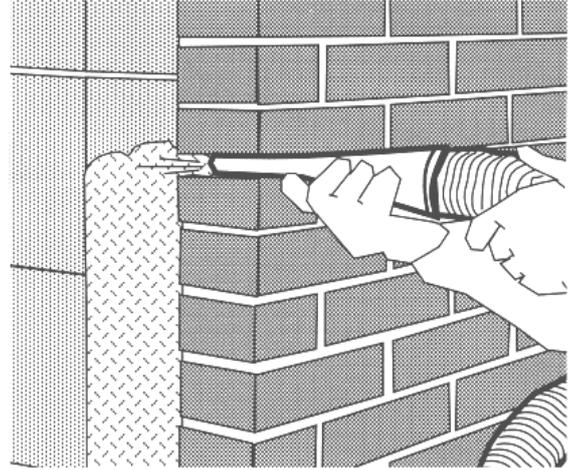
Remplissage par injection d'isolants sous forme de mousse
